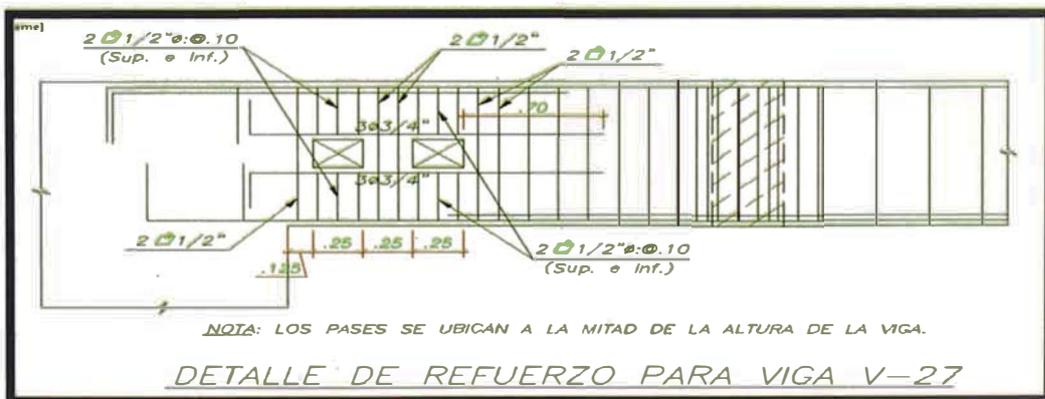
Refuerzo en viga por bandeja- ubicado fuera del tercio central.
